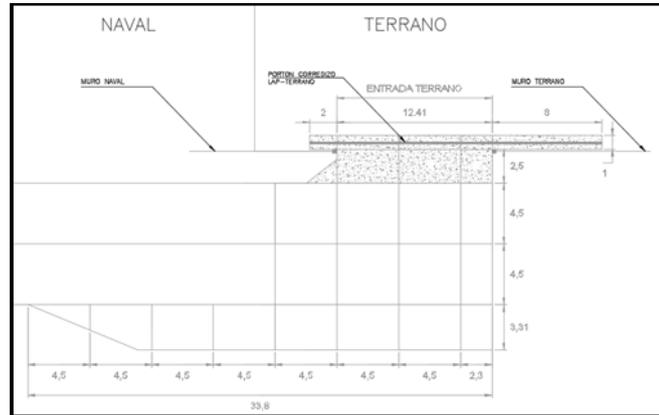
Vista en planta de losa base del portón LAP-TERRANO.
